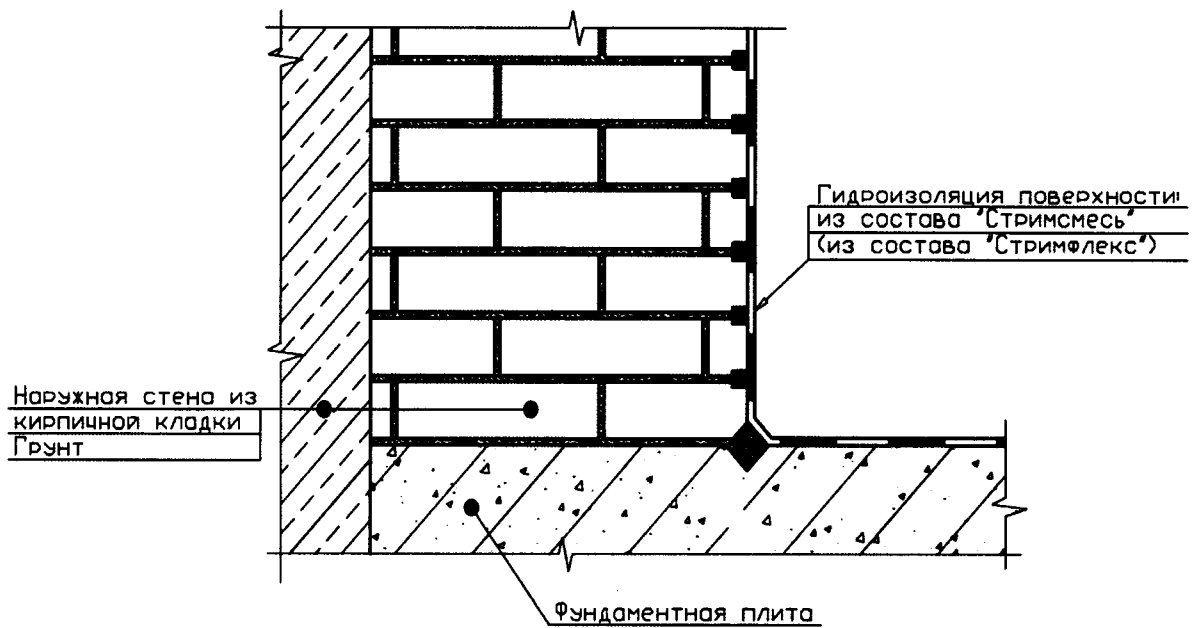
Гидроизоляция поверхностей конструкций из кирпичной кладки.
